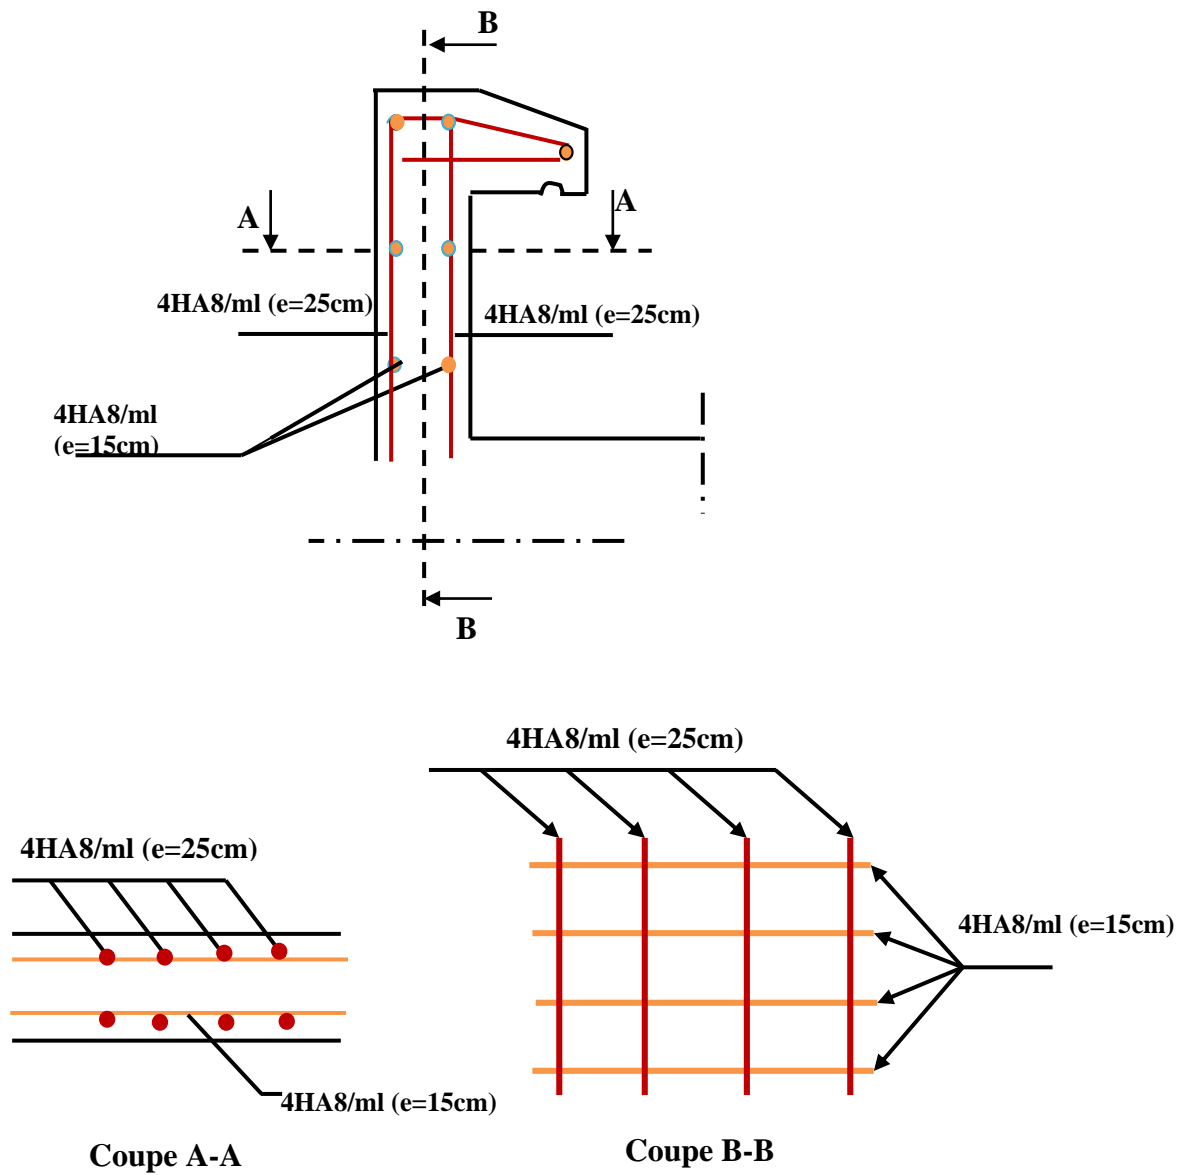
Schémas de ferrailage de l'acrotère.
